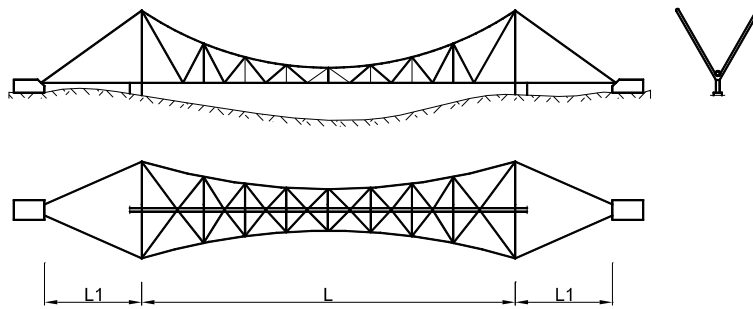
Traversare suspendată cu piloni în formă de Y
